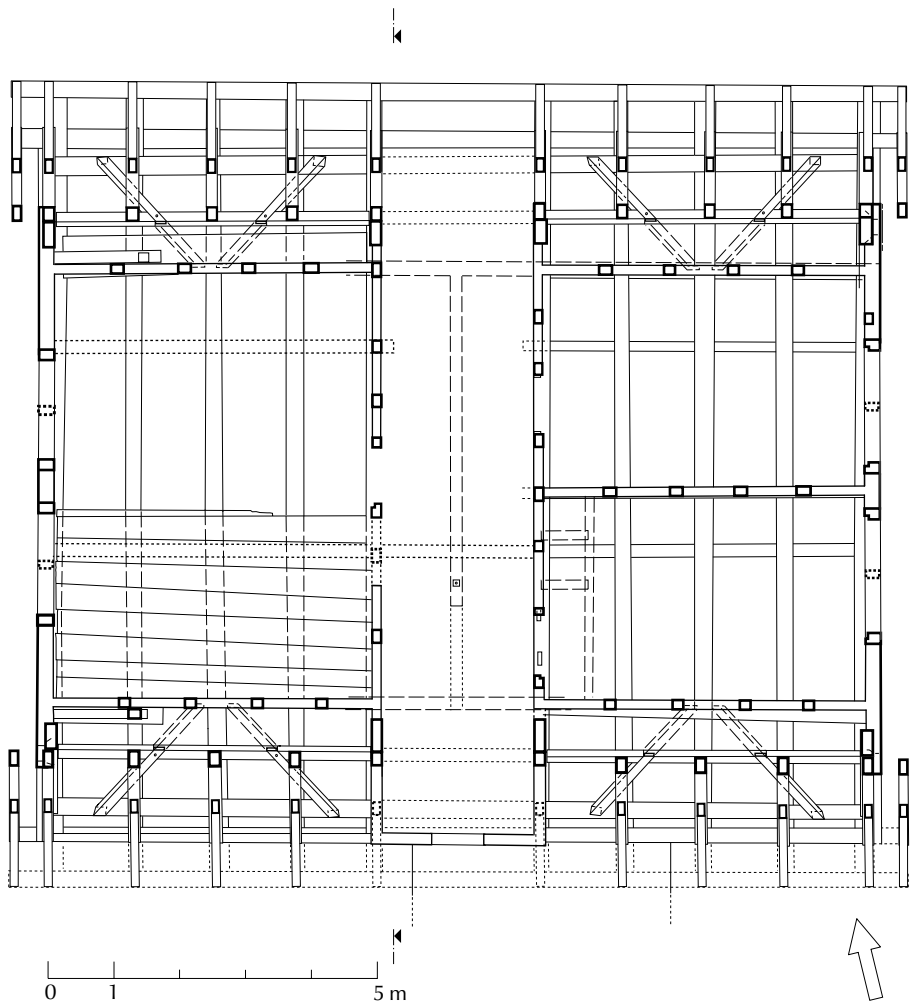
Grundriss des unteren Dachgeschosses.
